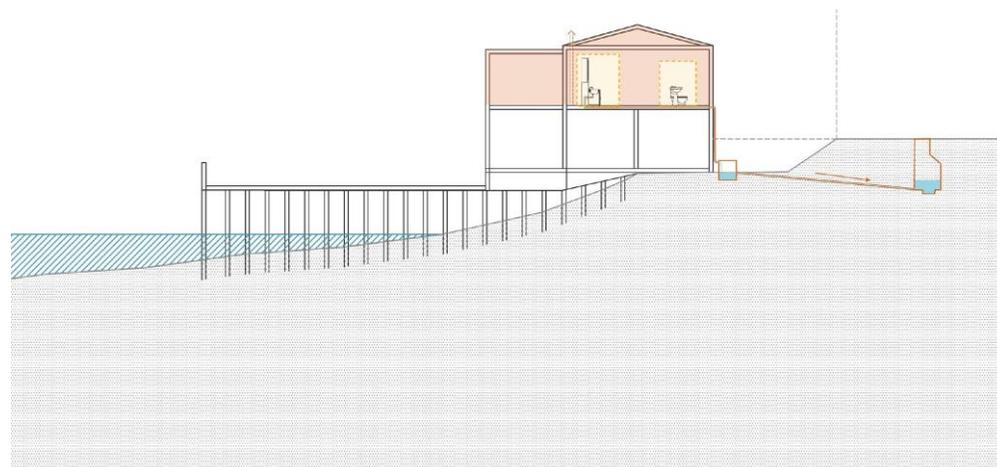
Corte explicativo de solución propuesta para las viviendas de 1 piso.
